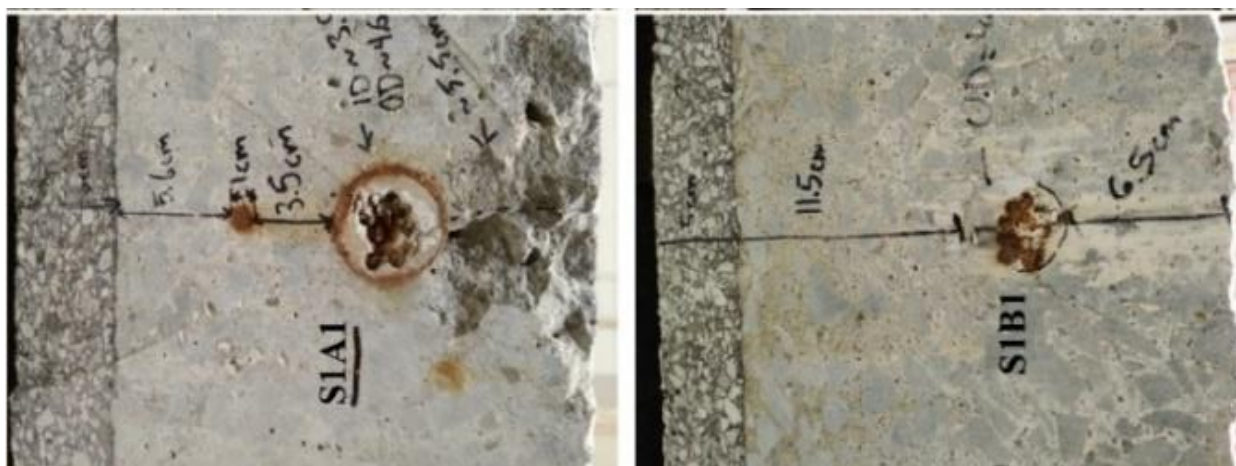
Corrosión en Armaduras de Hormigón. Fuente: (Tawil et al., 2024).
